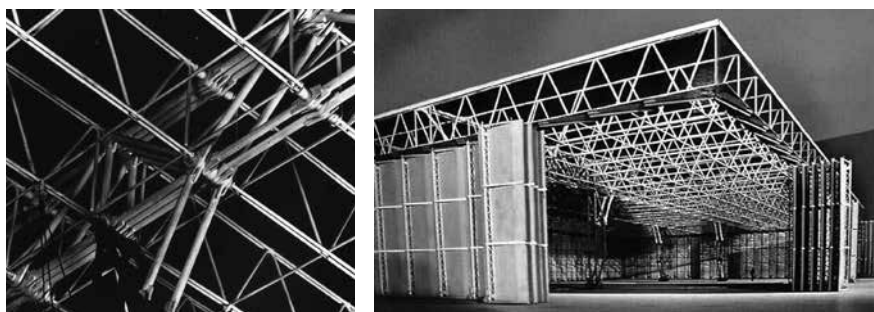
Mobilar structure, dettaglio e vista d'insieme, 1943-45.
